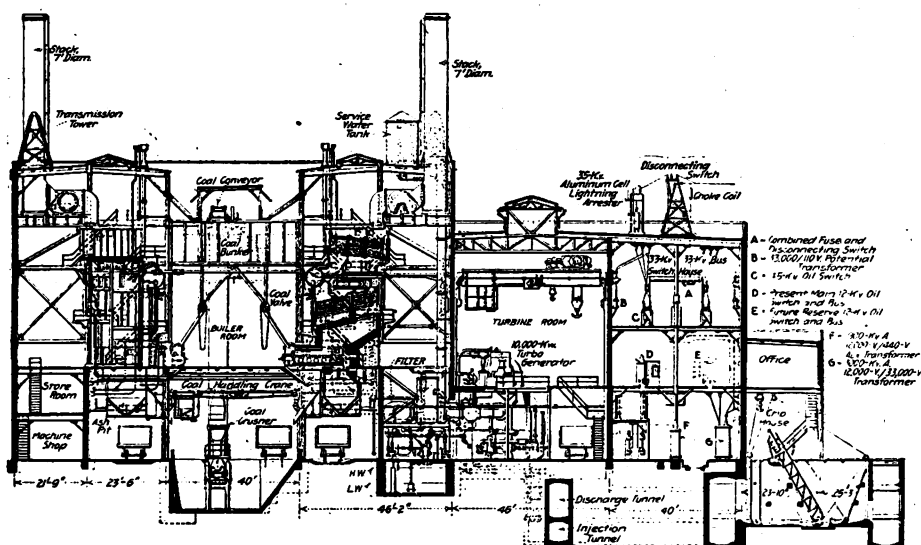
Coupe transversale de la station Joliet à haute pression et à haute surchauffe.
